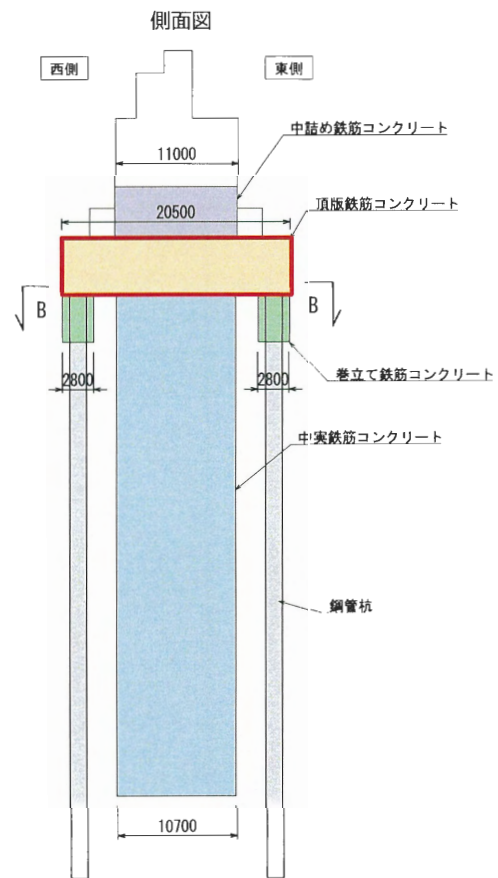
頂版鉄筋コンクリートの配筋図 (2/3)
